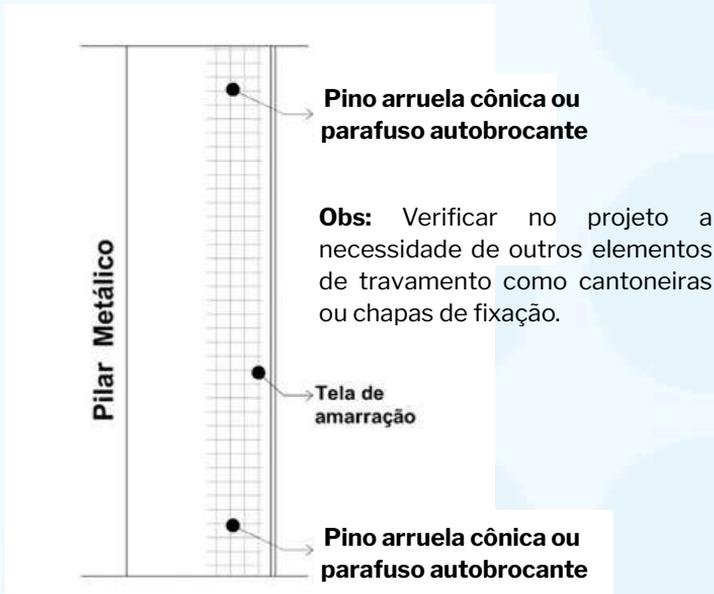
Demonstração da aplicação de tela de alvenaria para formar ponte de aderência entre o perfil metálico e o Painel Lightwall
